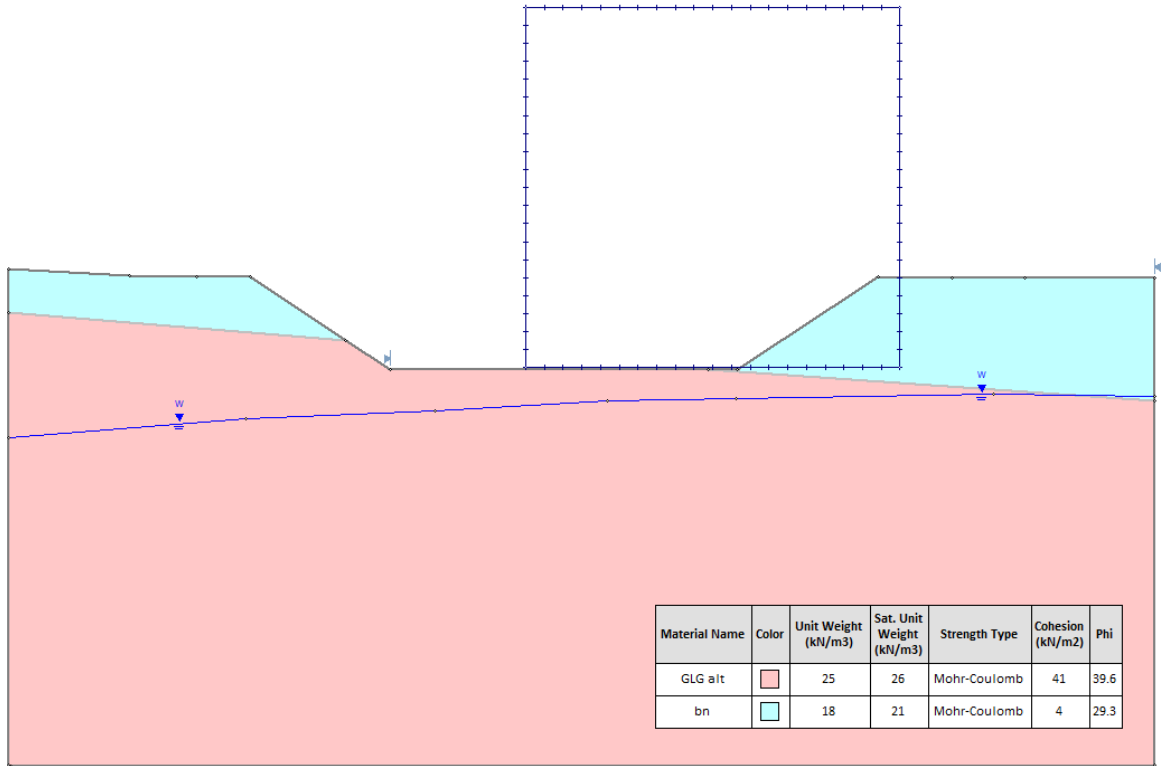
Scavo provvisorio Spalla 1 Viadotto Argomenna alla p.k. 1+781: modello di calcolo
